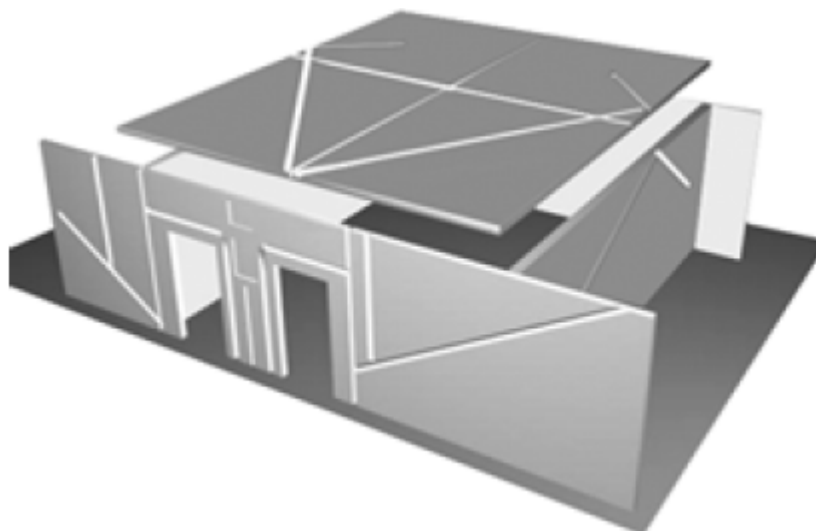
Схема прокладки электропроводки в каналах панельного дома
